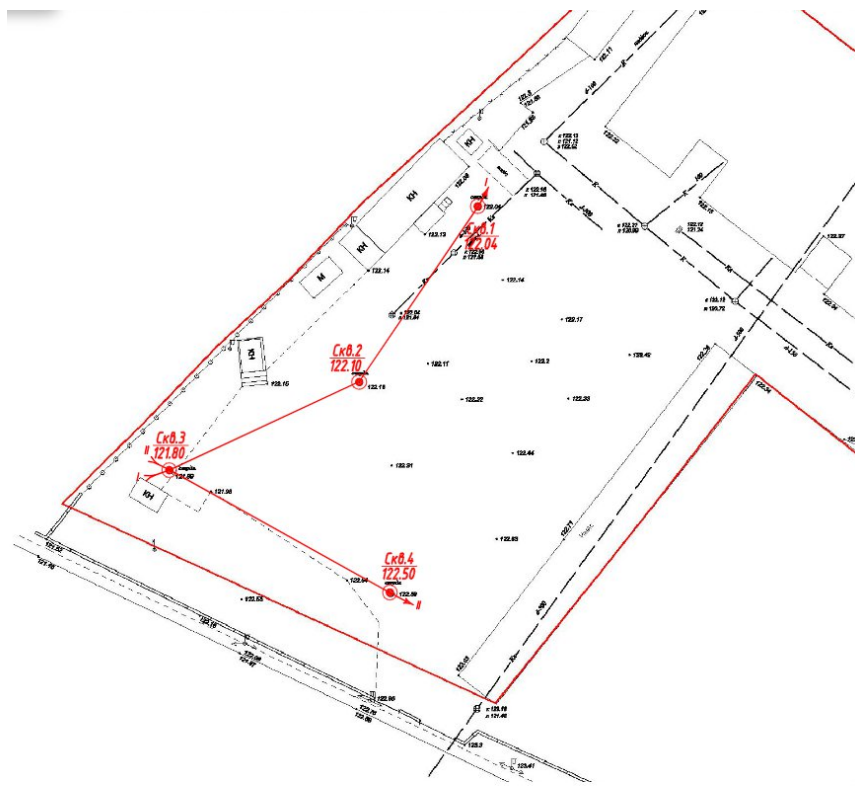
Схема розташування інженерно-геологічних свердловин на території будівництва
